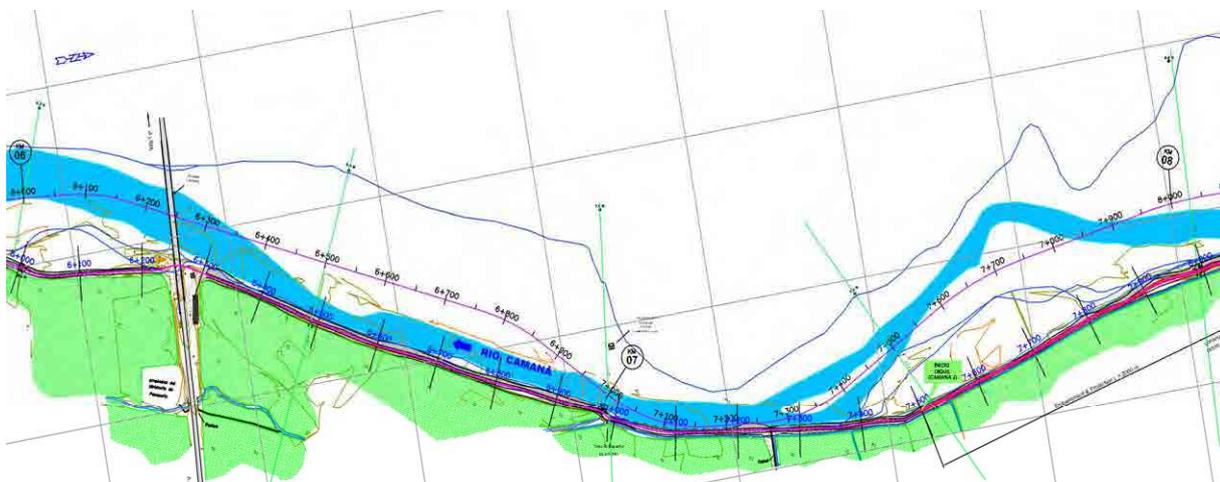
Planta de instalaciones Caman-2 (2)
